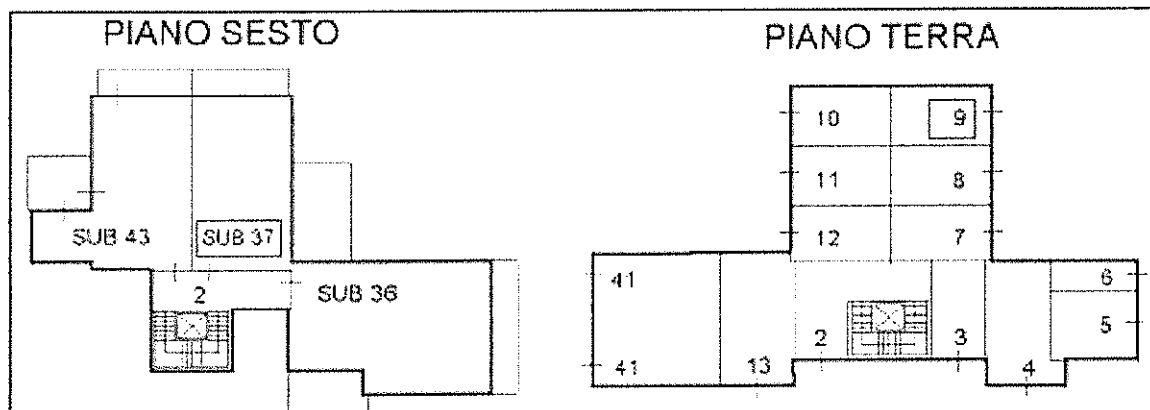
elaborato planimetrico del 6° piano e del piano terra
